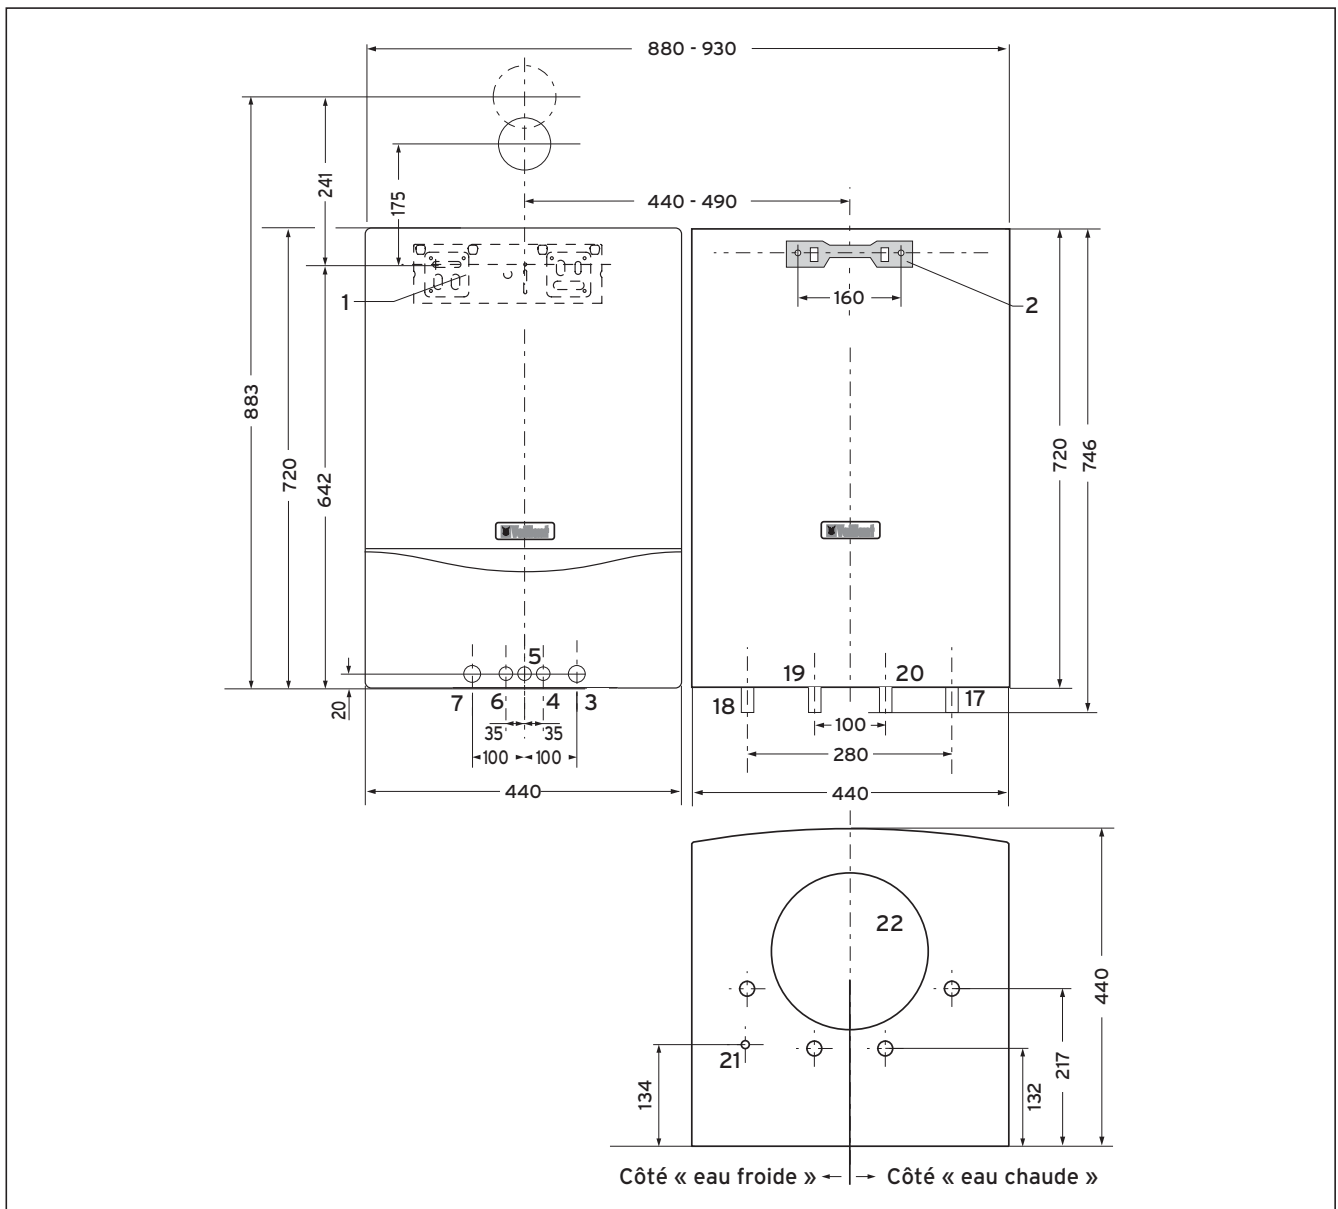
Dimensions pour le montage à côté de l'appareil de chauffage
